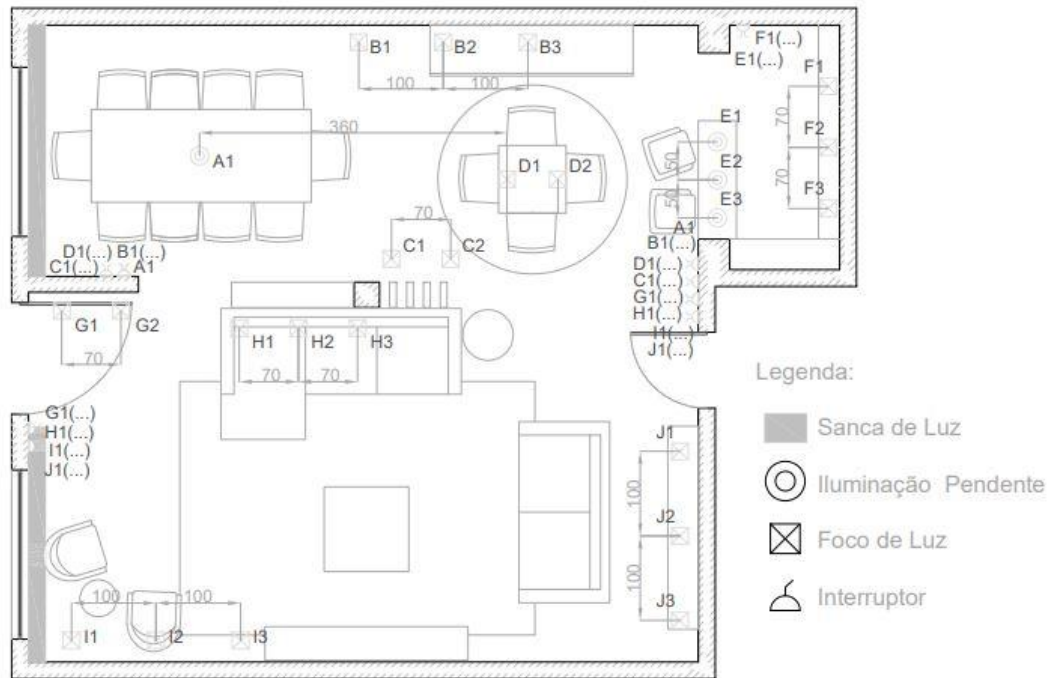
Planta de Iluminação Cotada Projeto Lino
